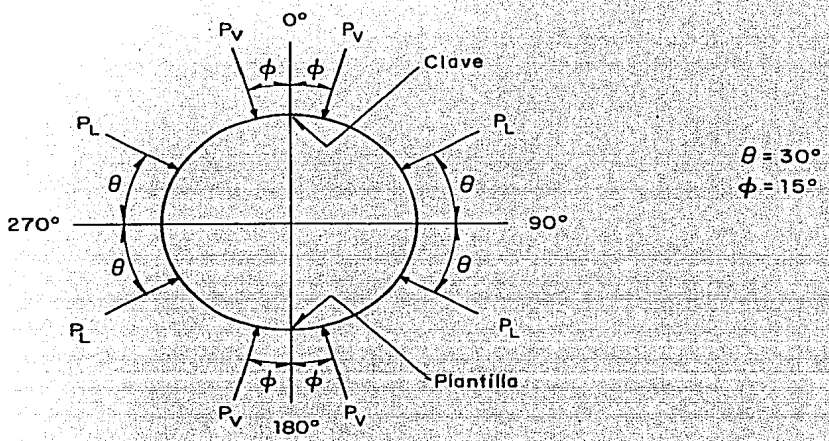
Distribución de las cargas aplicadas en el laboratorio
